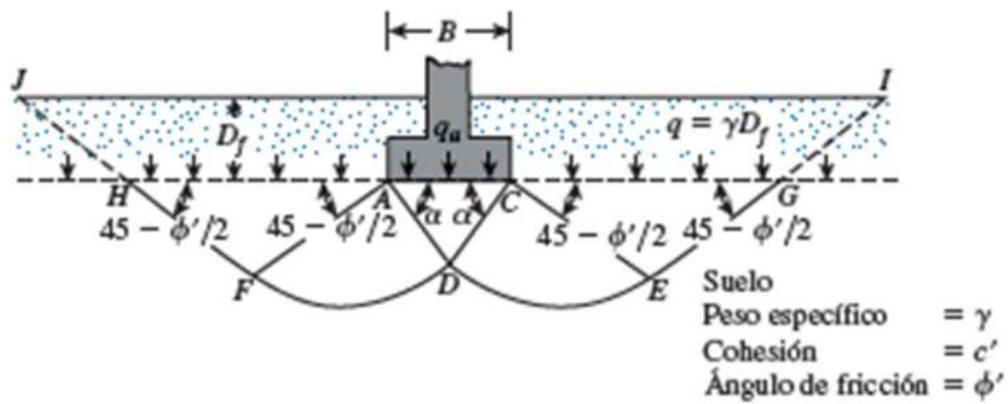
Falla por capacidad de carga en un suelo bajo una cimentación rígida continua (corrida)
